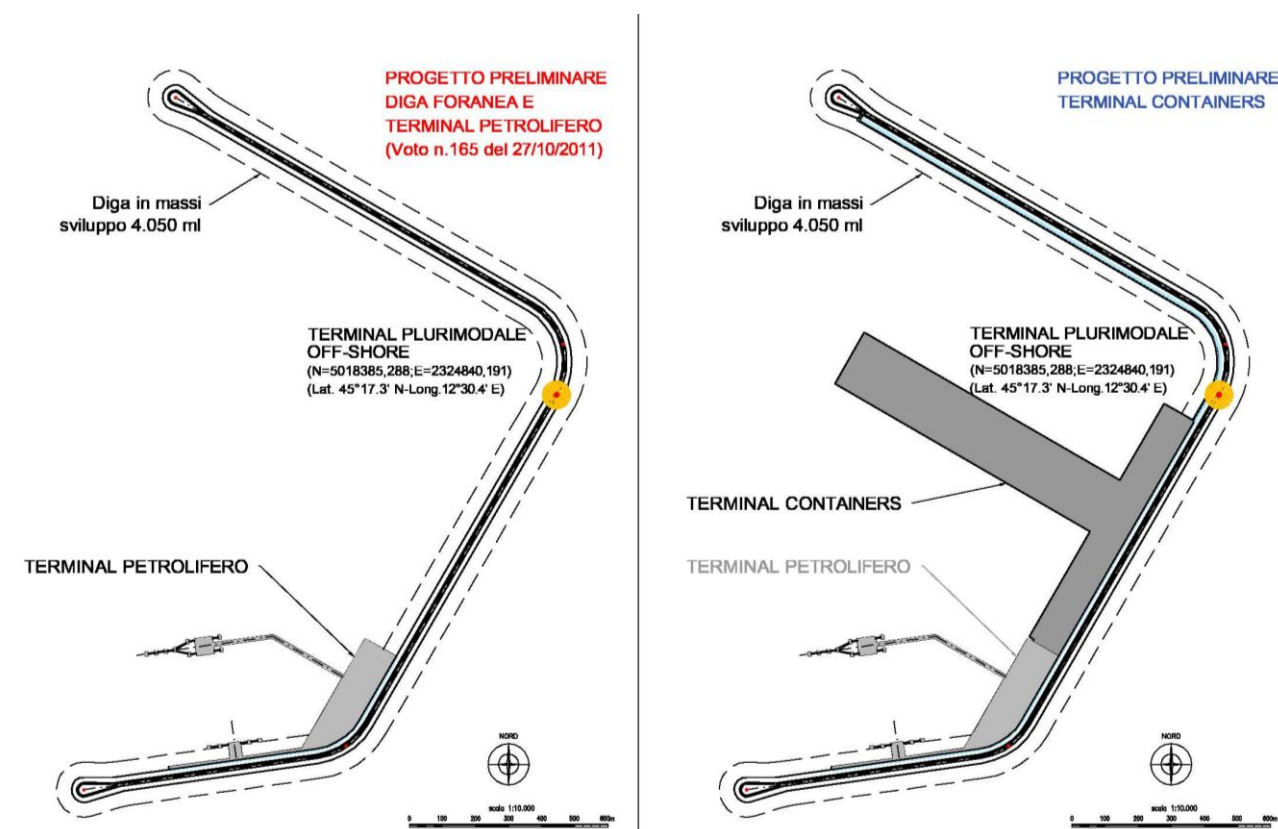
Raffronto tra la planimetria del Terminal del Progetto Preliminare approvato in Ottobre 2011 e la configurazione prevista nel presente progetto
